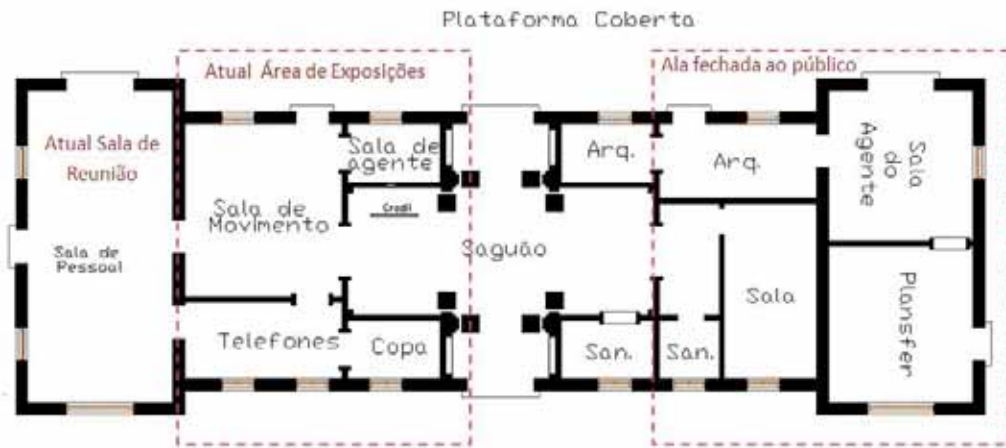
Uso atual da Estação, em planta. Fonte: Arquivo pessoal.
